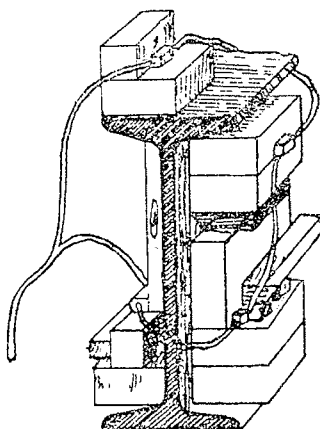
Detalle de la colocación de las cargas en un perfil doble T
